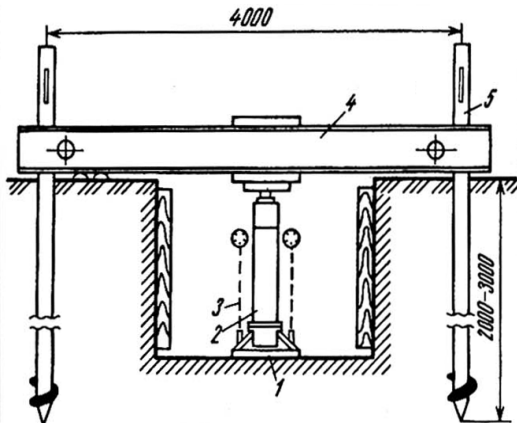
Схема испытания грунтов статическими нагрузками:
